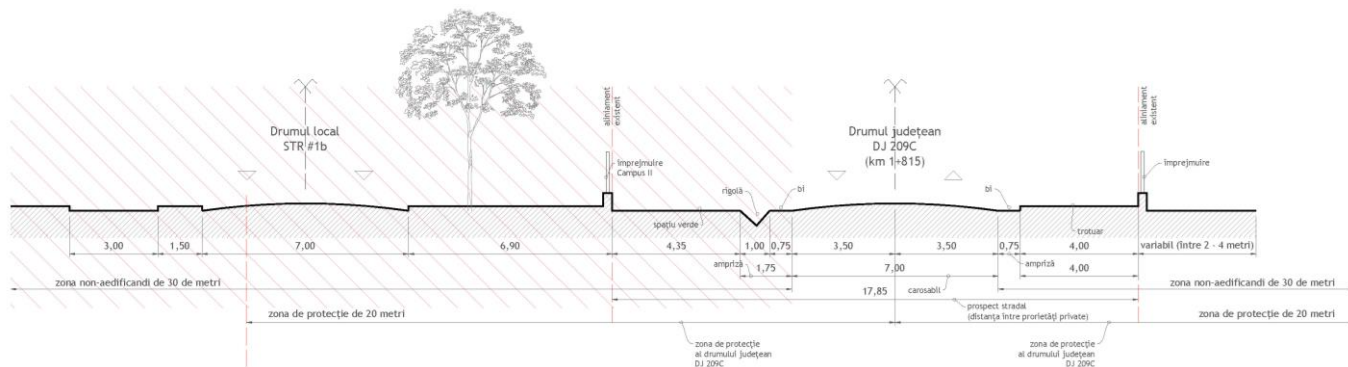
Secțiune locală prin DJ209C și strada locală #1b, „km 1+815”
